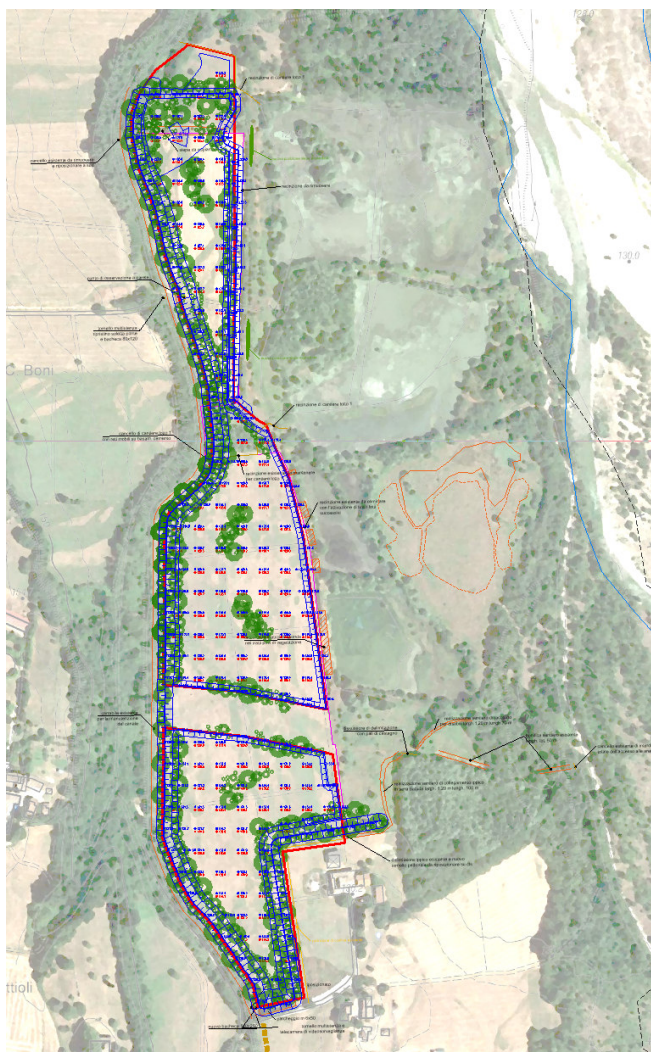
Estratto Tav S02 'Progetto di recupero'
